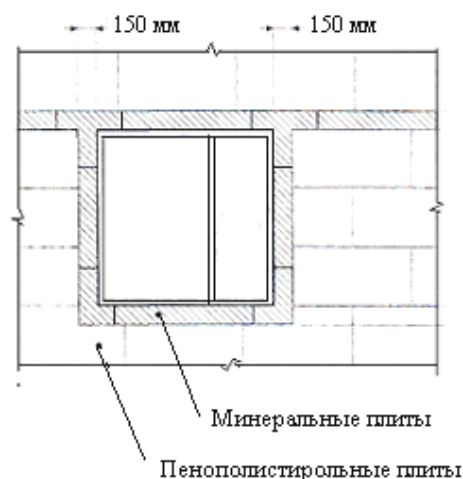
Установка противопожарных обрамлений из минераловатных плит вокруг оконного проема
